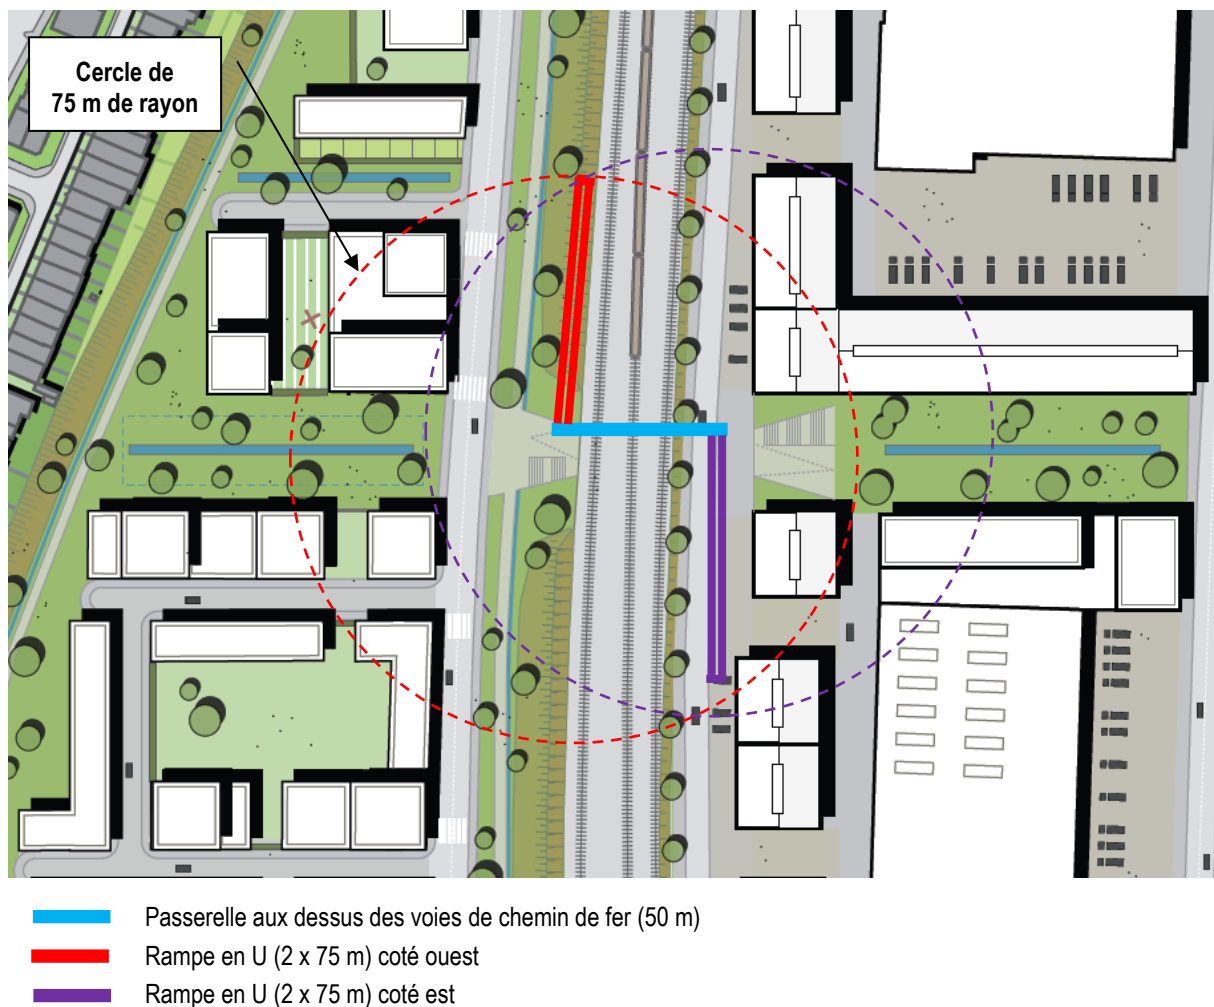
Schéma d'implantation d'une passerelle (ARIES sur fond MSA, 2015)
